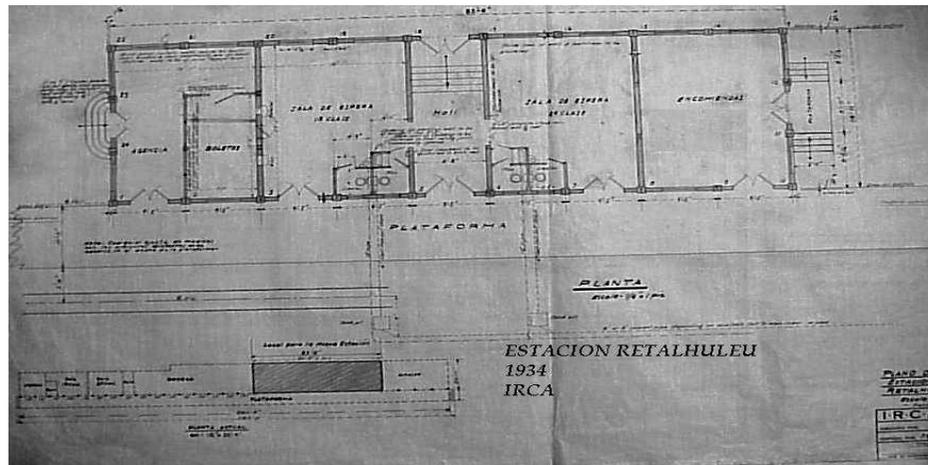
Se observa el plano de la nueva estación. Fuente FEGUA
